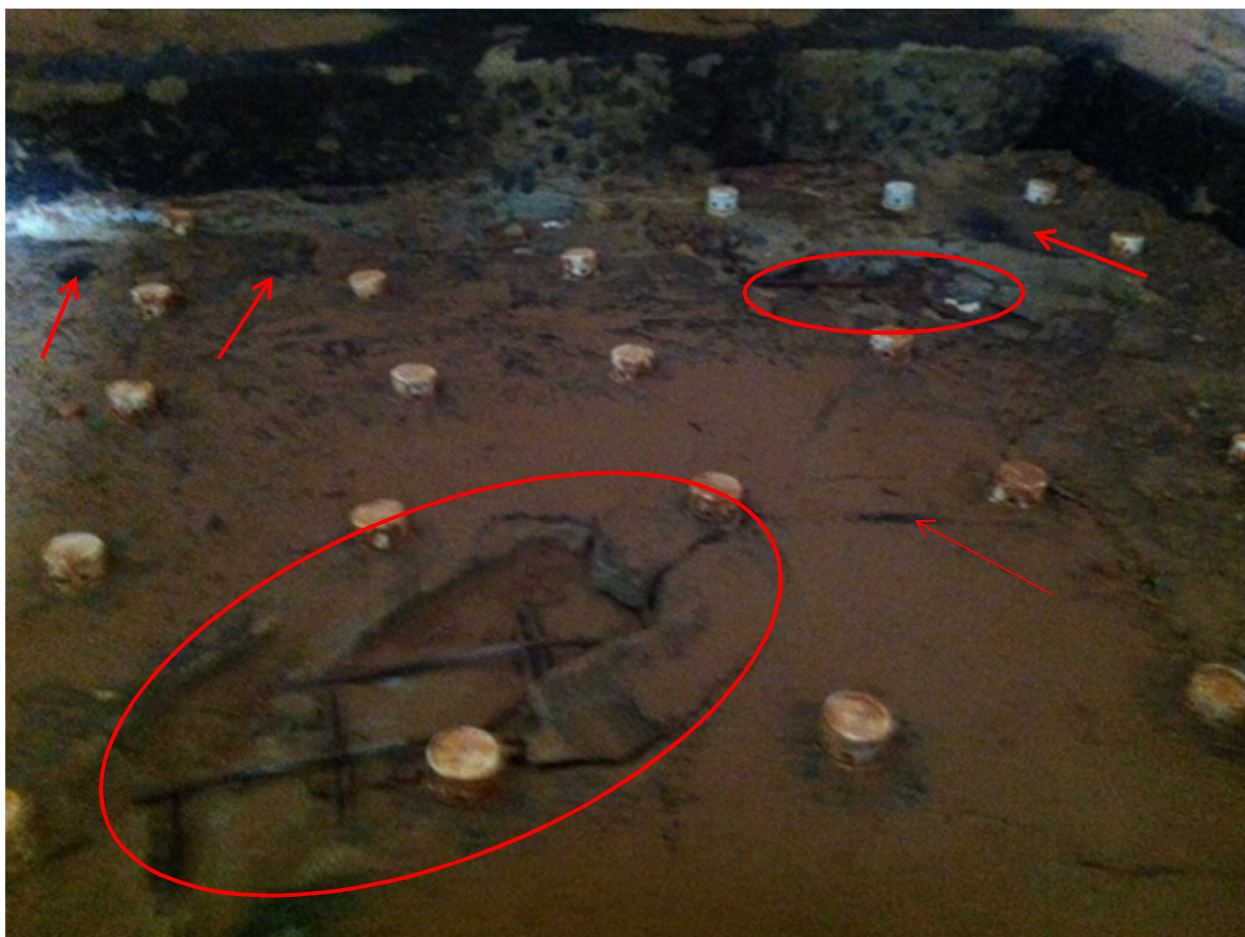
deterioração do concreto de cobertura e da armadura de aço.
